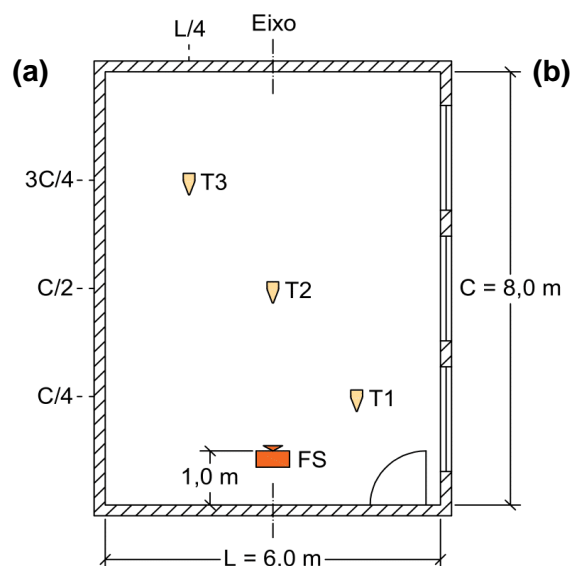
(a) Medição do tempo de reverberação na situação de referência SV2 (sala de aula vazia, com o painel termoacústico e um resíduo têxtil proveniente da reciclagem de pneus, aplicados na face interior da parede de fachada); (b) planta esquemática da sala de aula, com a posição da fonte sonora (FS) e as diferentes posições medidas pelo sonómetro (T1, T2 e T3) assinaladas
